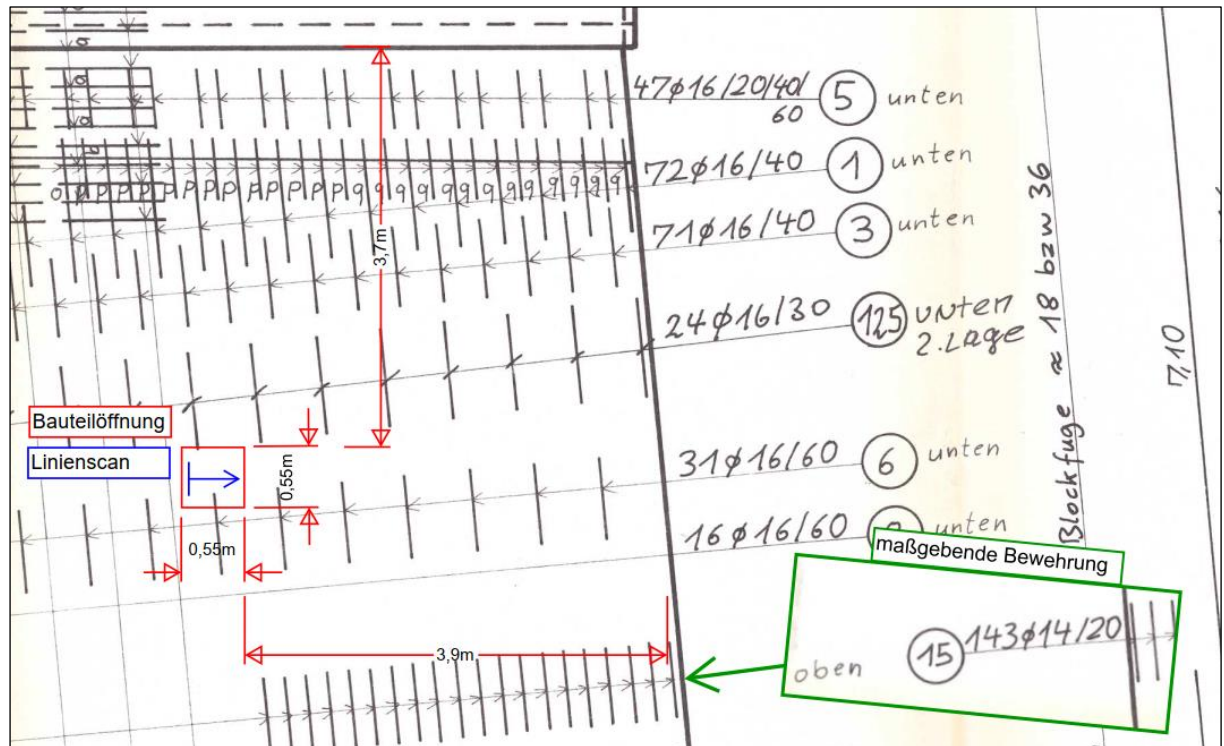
Ausschnitt aus Plan B_2_30a_ (30-11-1988) – bei Bauteilöffnung FB2
